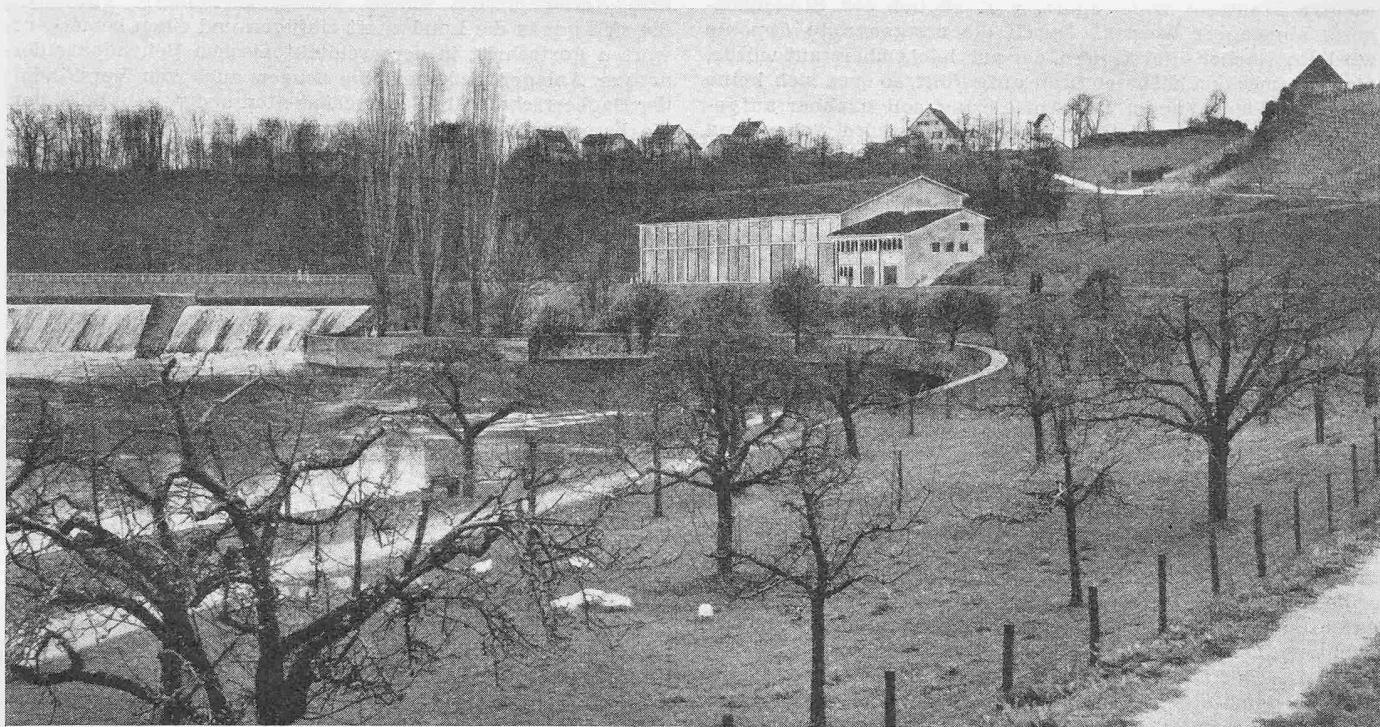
Maschinenhaus und Stauwehr, Variante mit schrägem Ziegeldach
